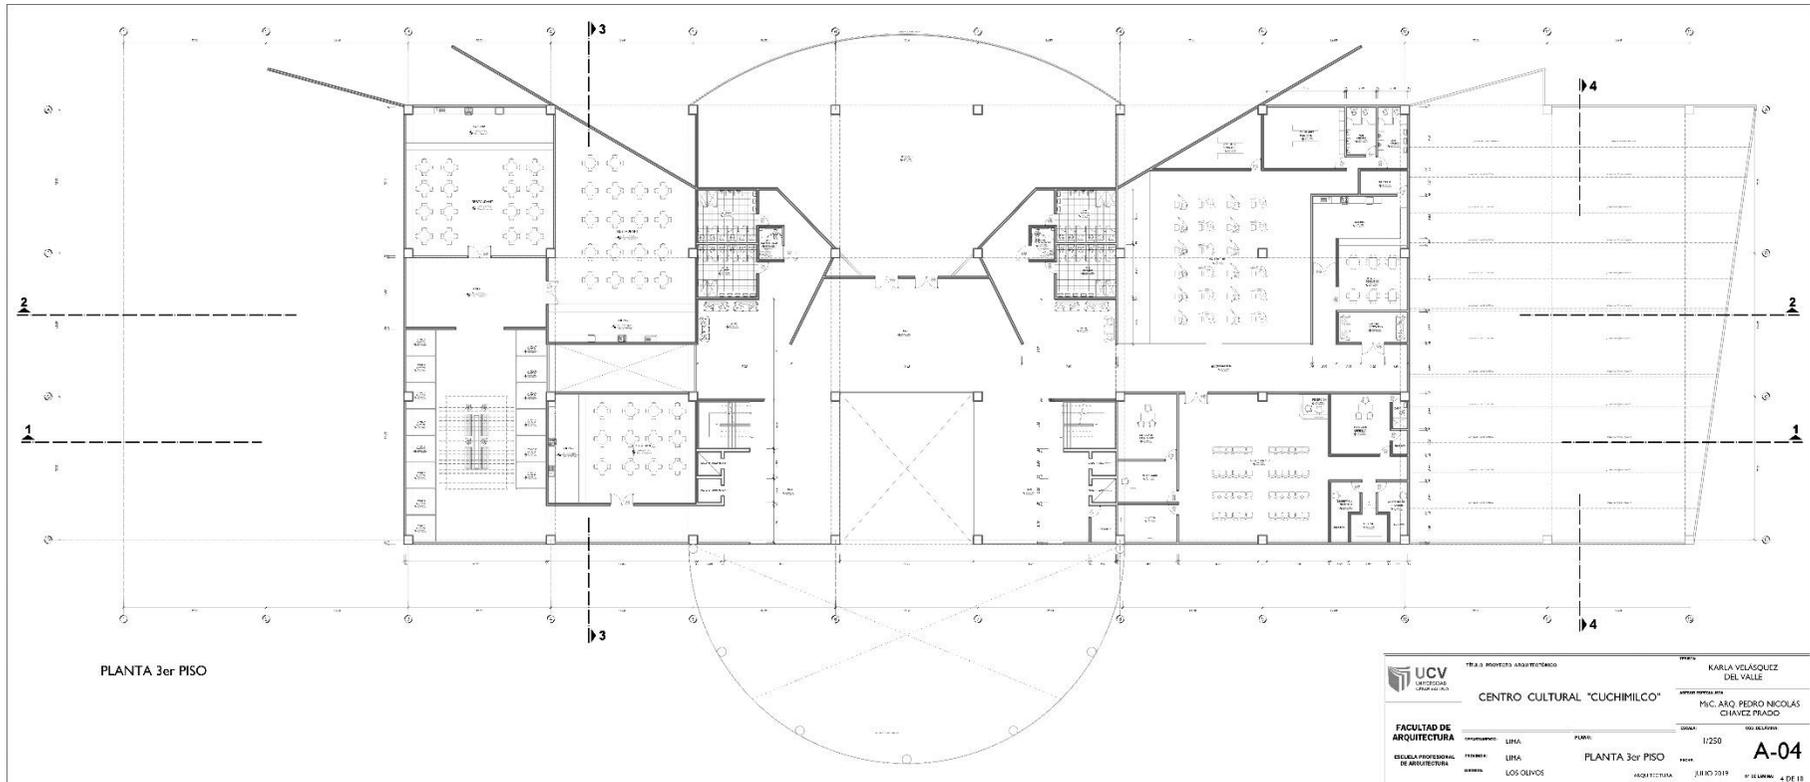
Plano de Arquitectura Planta 3er Piso. Elaboración propia
